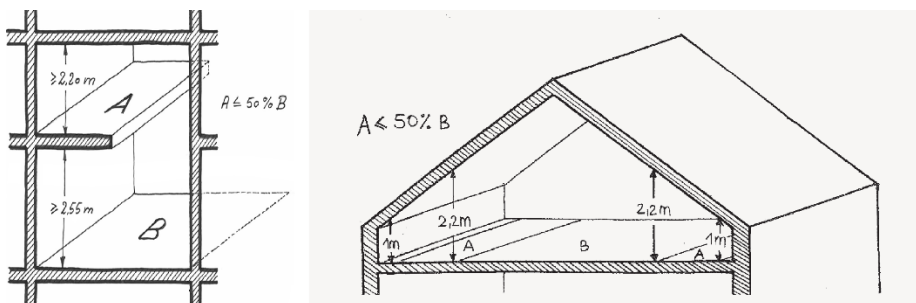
Hauteur libre sous plafond en cas d'une mezzanine ou de combles
